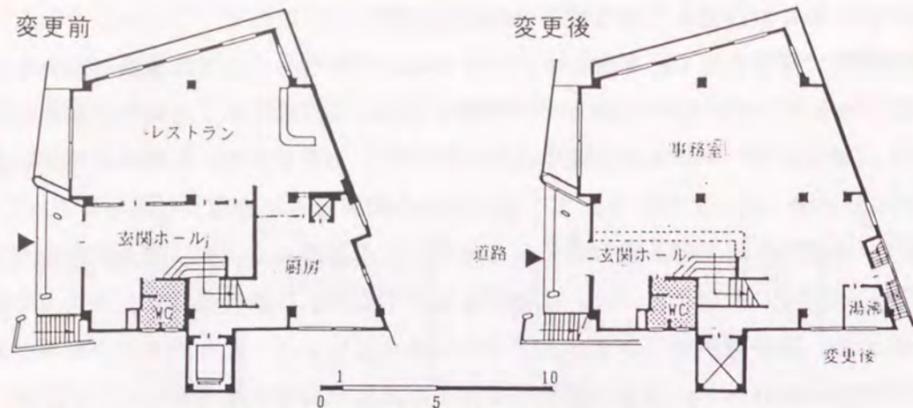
<109>日上市分庁舎(旧レストラン)1階平面図
